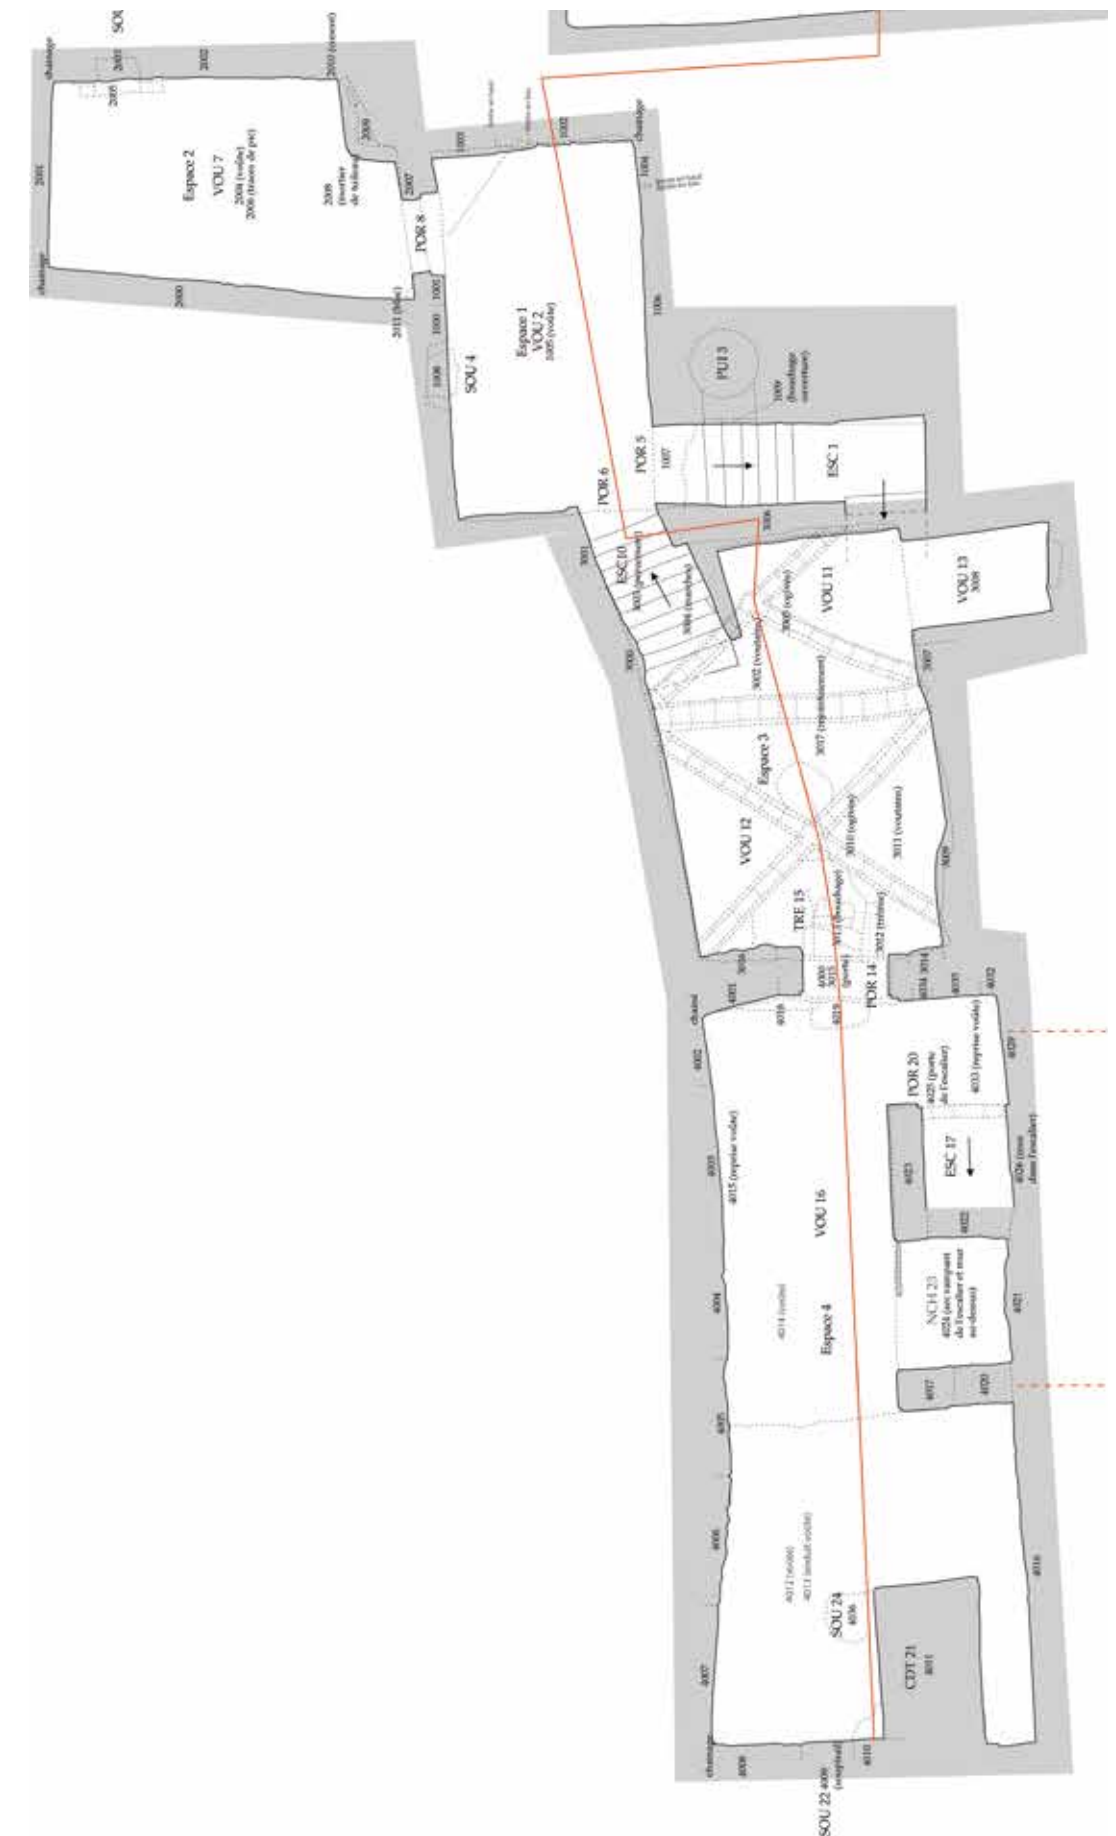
Plan général de la cave SICAVOR 4-5.
